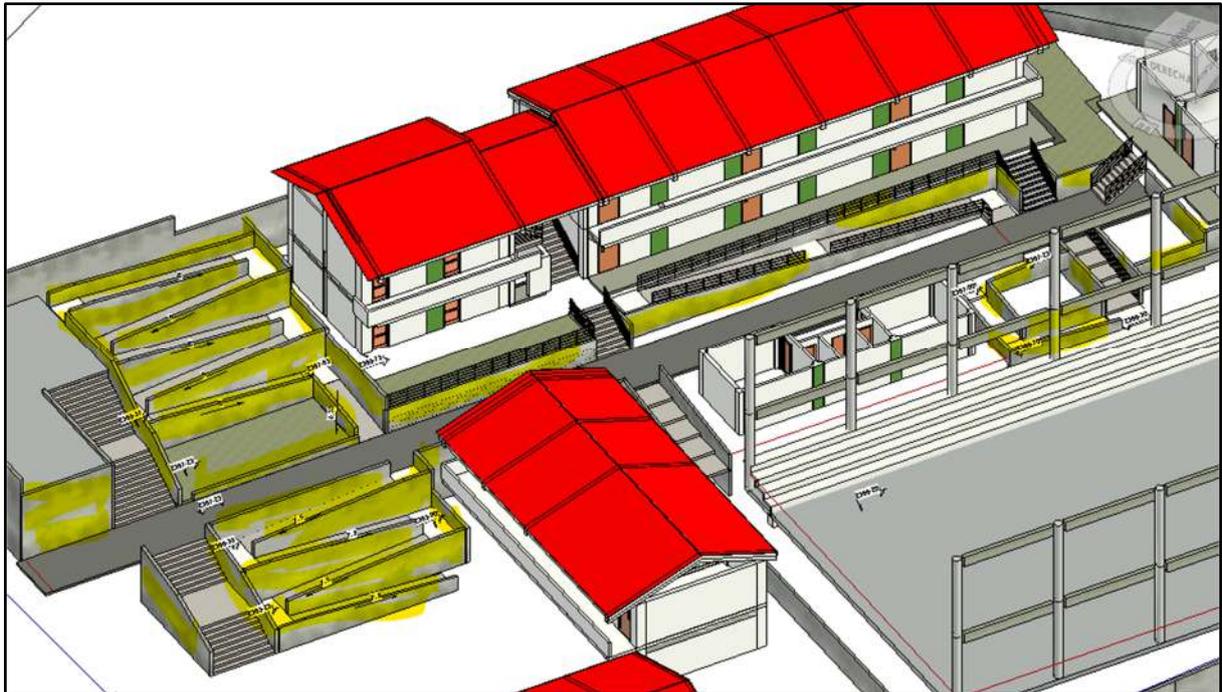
Techo a dos aguas (Plano de replanteo de arquitectura)
